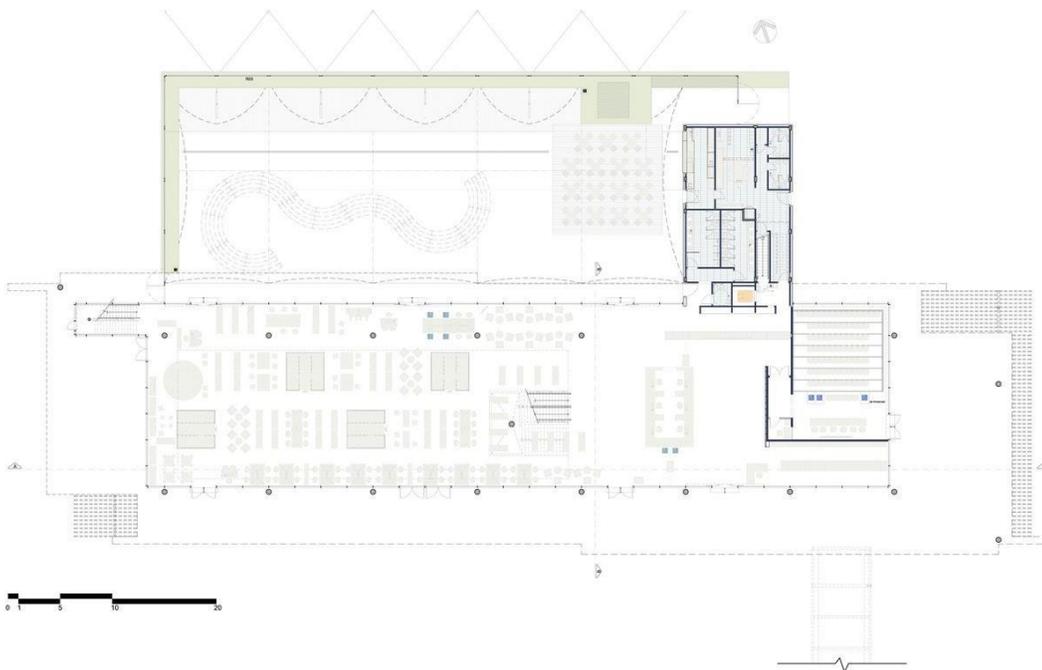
Planta baixa da Biblioteca de São Paulo, 2010. Fonte: Archdaily. Autor: Afalo&Gasparini.
